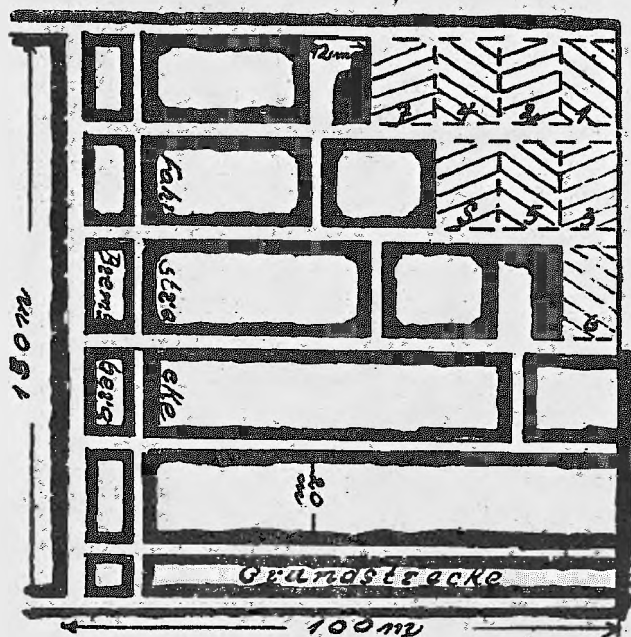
Streichender Pfeilerrückbau (Bruchbau)
